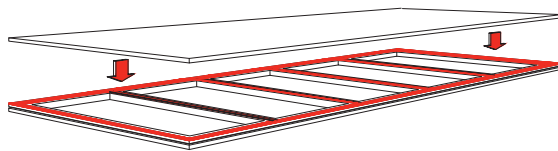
Aplicación de cinta CAP para panel arquitectónico.
